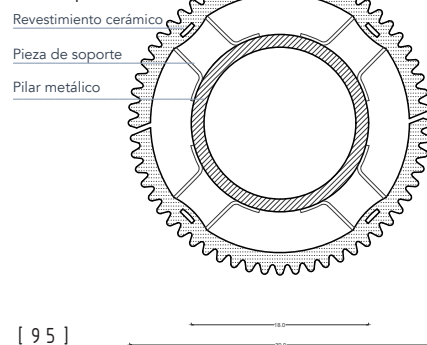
Elaboración propia a partir de revista AV Proyectos Pabellón de España. Detalle sección de pilares.
